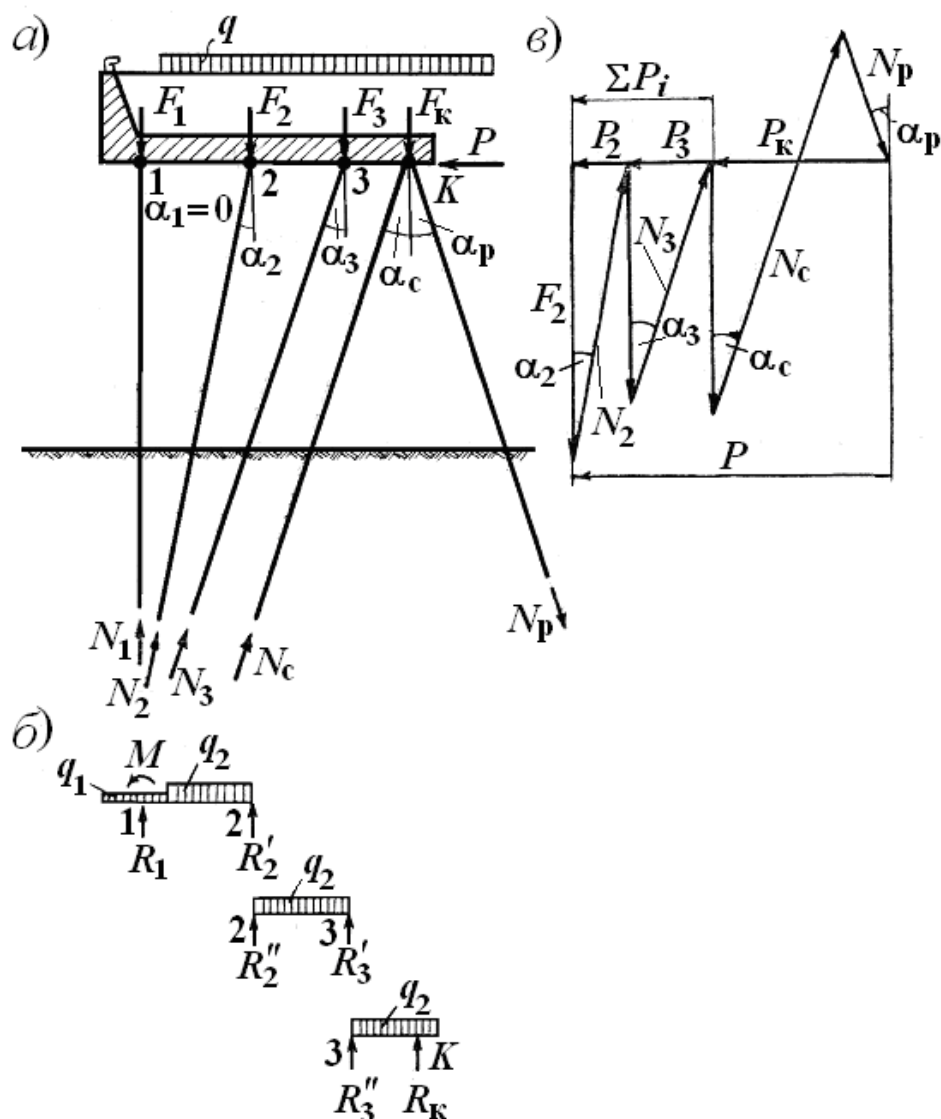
К определению усилий в сваях при нежестком ростверке: а — расчетная схема; б — определение вертикальных нагрузок на свайные ряды; в — определение усилий в наклонных сваях от горизонтальной нагрузки
